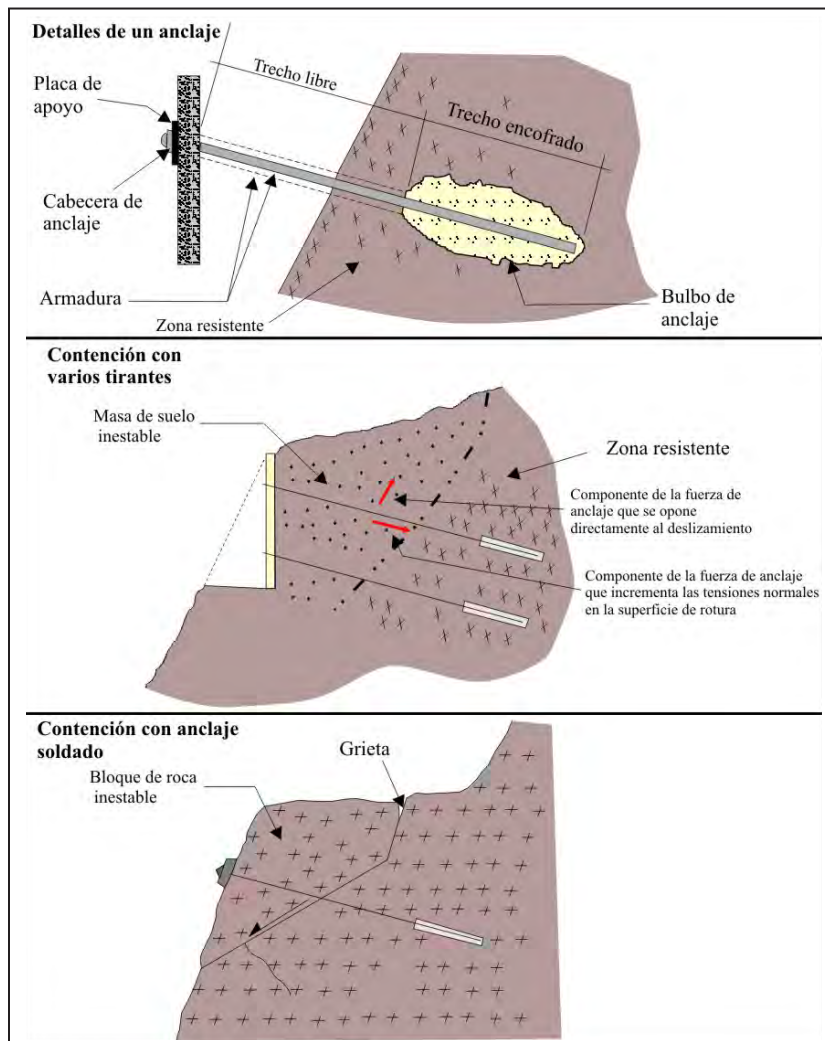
Detalles de un anclaje y ejemplos de aplicación.
